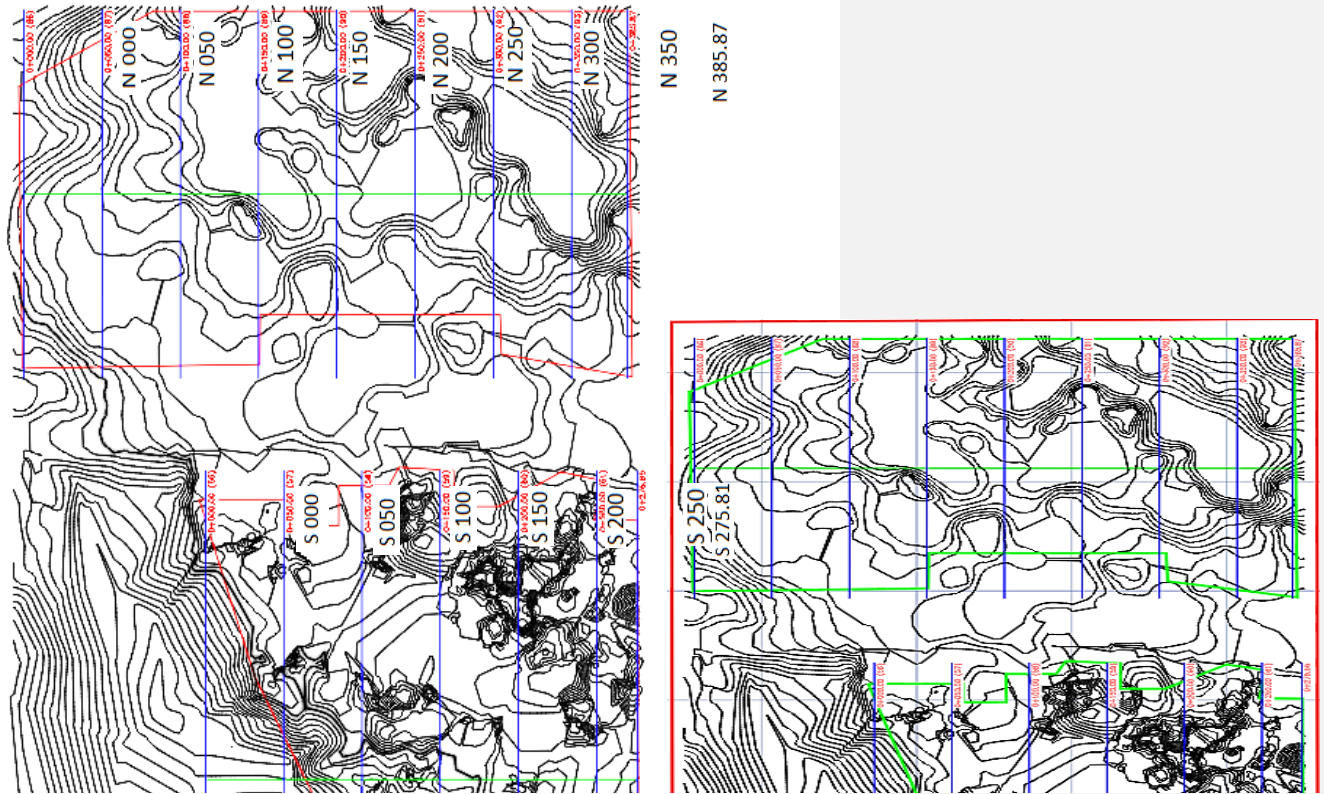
Perfiles Secciones de los frentes norte y sur del yacimiento "San Rafael" visto en planta
